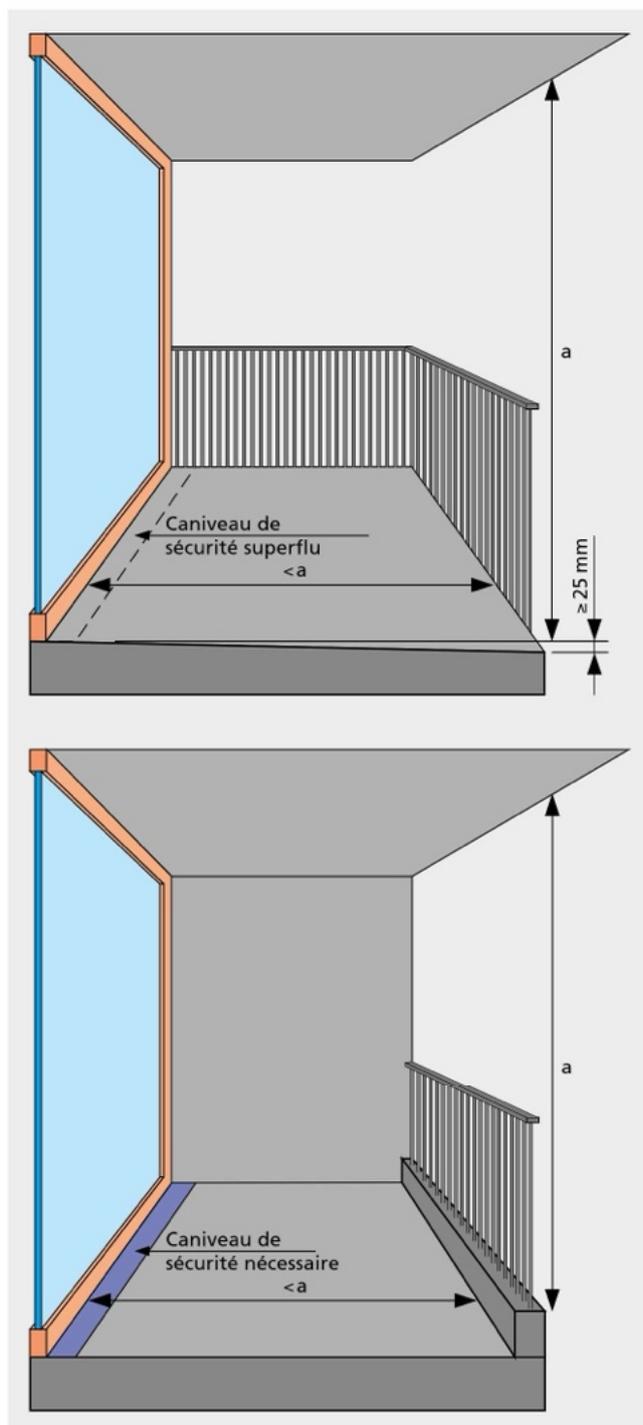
Sur les balcons et coursives avec une hauteur de déversement libre sur la longueur et se situant 25 mm sous le raccord au seuil, on peut renoncer à un caniveau de sécurité, mais pas si la hauteur de déversement est rehaussée.
